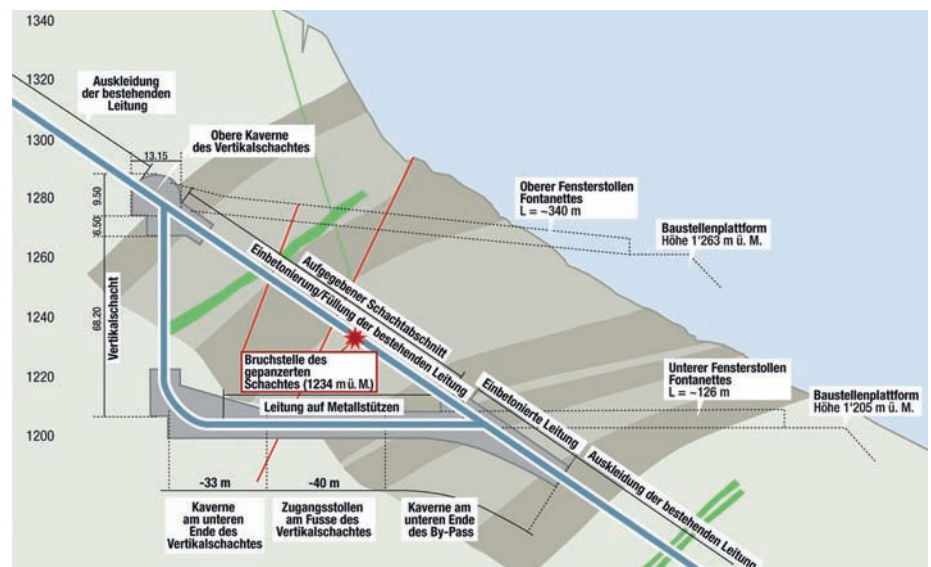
Anschluss des senkrechten Druckschachtes oben an den bestehenden Druckschacht am Ende des oberen Zugangsstollens
